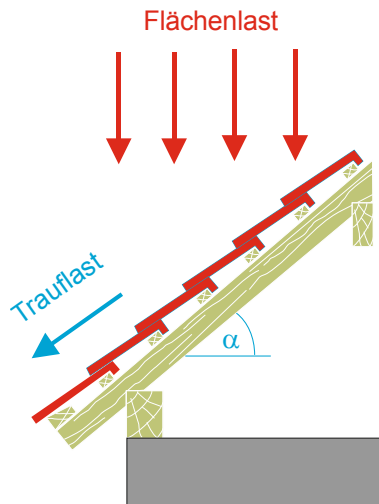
Wirkrichtung Flächenlast bzw. Trauflast
